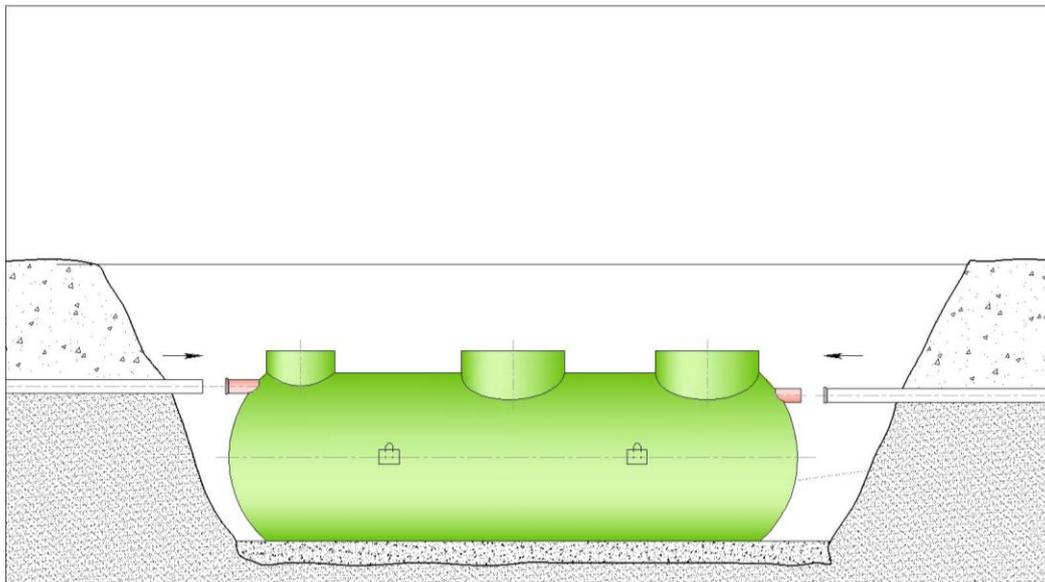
Установка резервуара на песчаную подготовку
